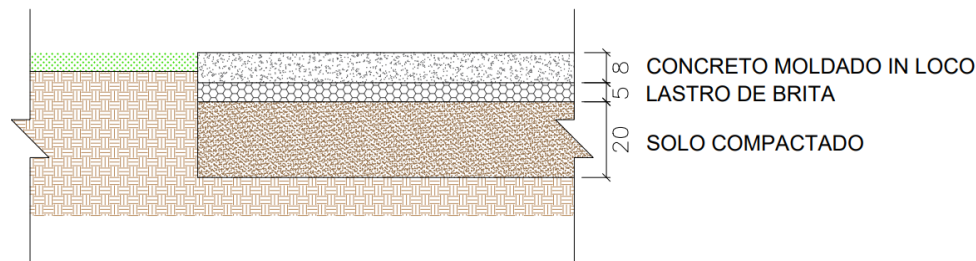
Detalhe Piso de Concreto Semi polido Moldado in loco
